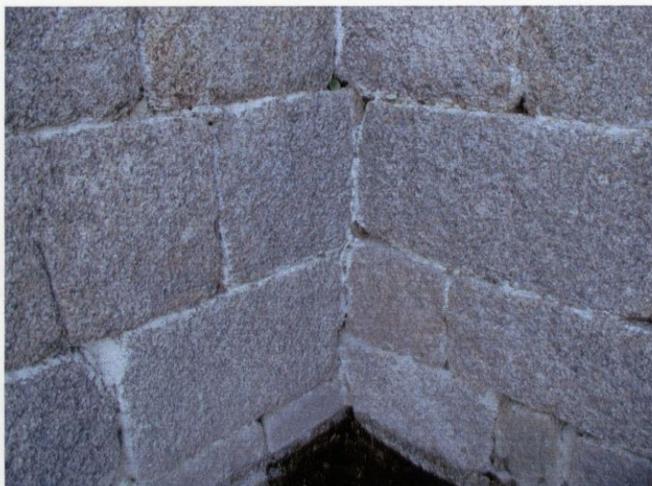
Sector SOA02/03. Detalle de paramentos en contacto entre capilla norte y muro norte de la iglesia
